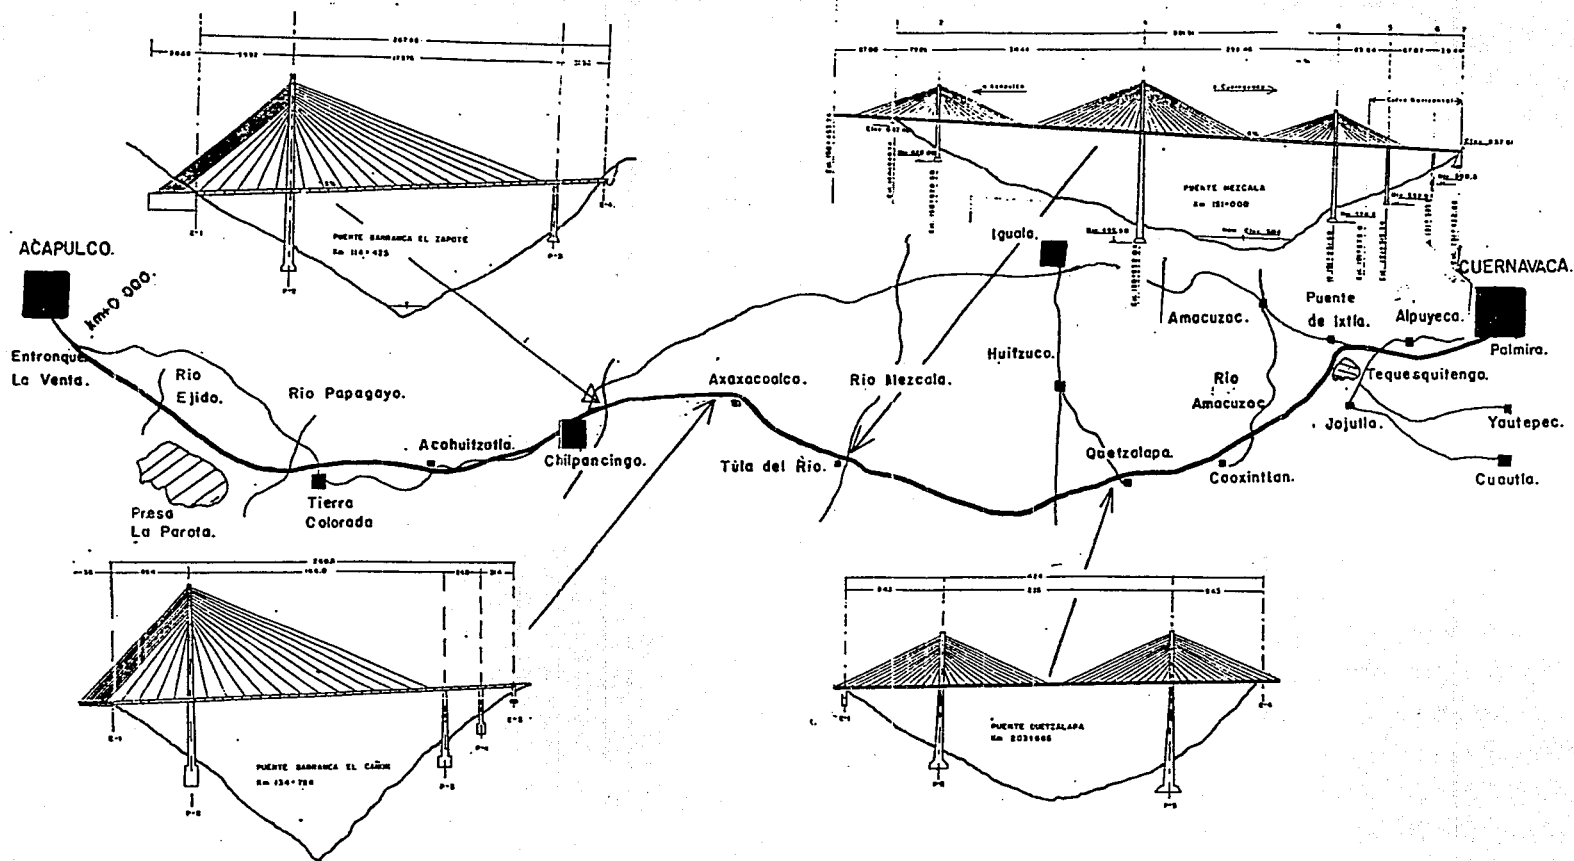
B.- Puentes atirantados en la autopista Cuernavaca Acapulco.
